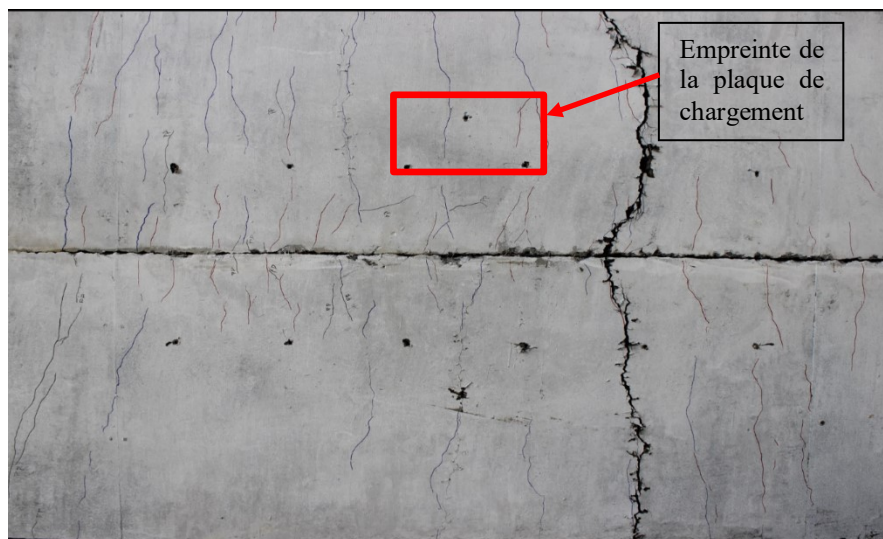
Fissuration sous la dalle en BFHP avec joint de connexion transversal
